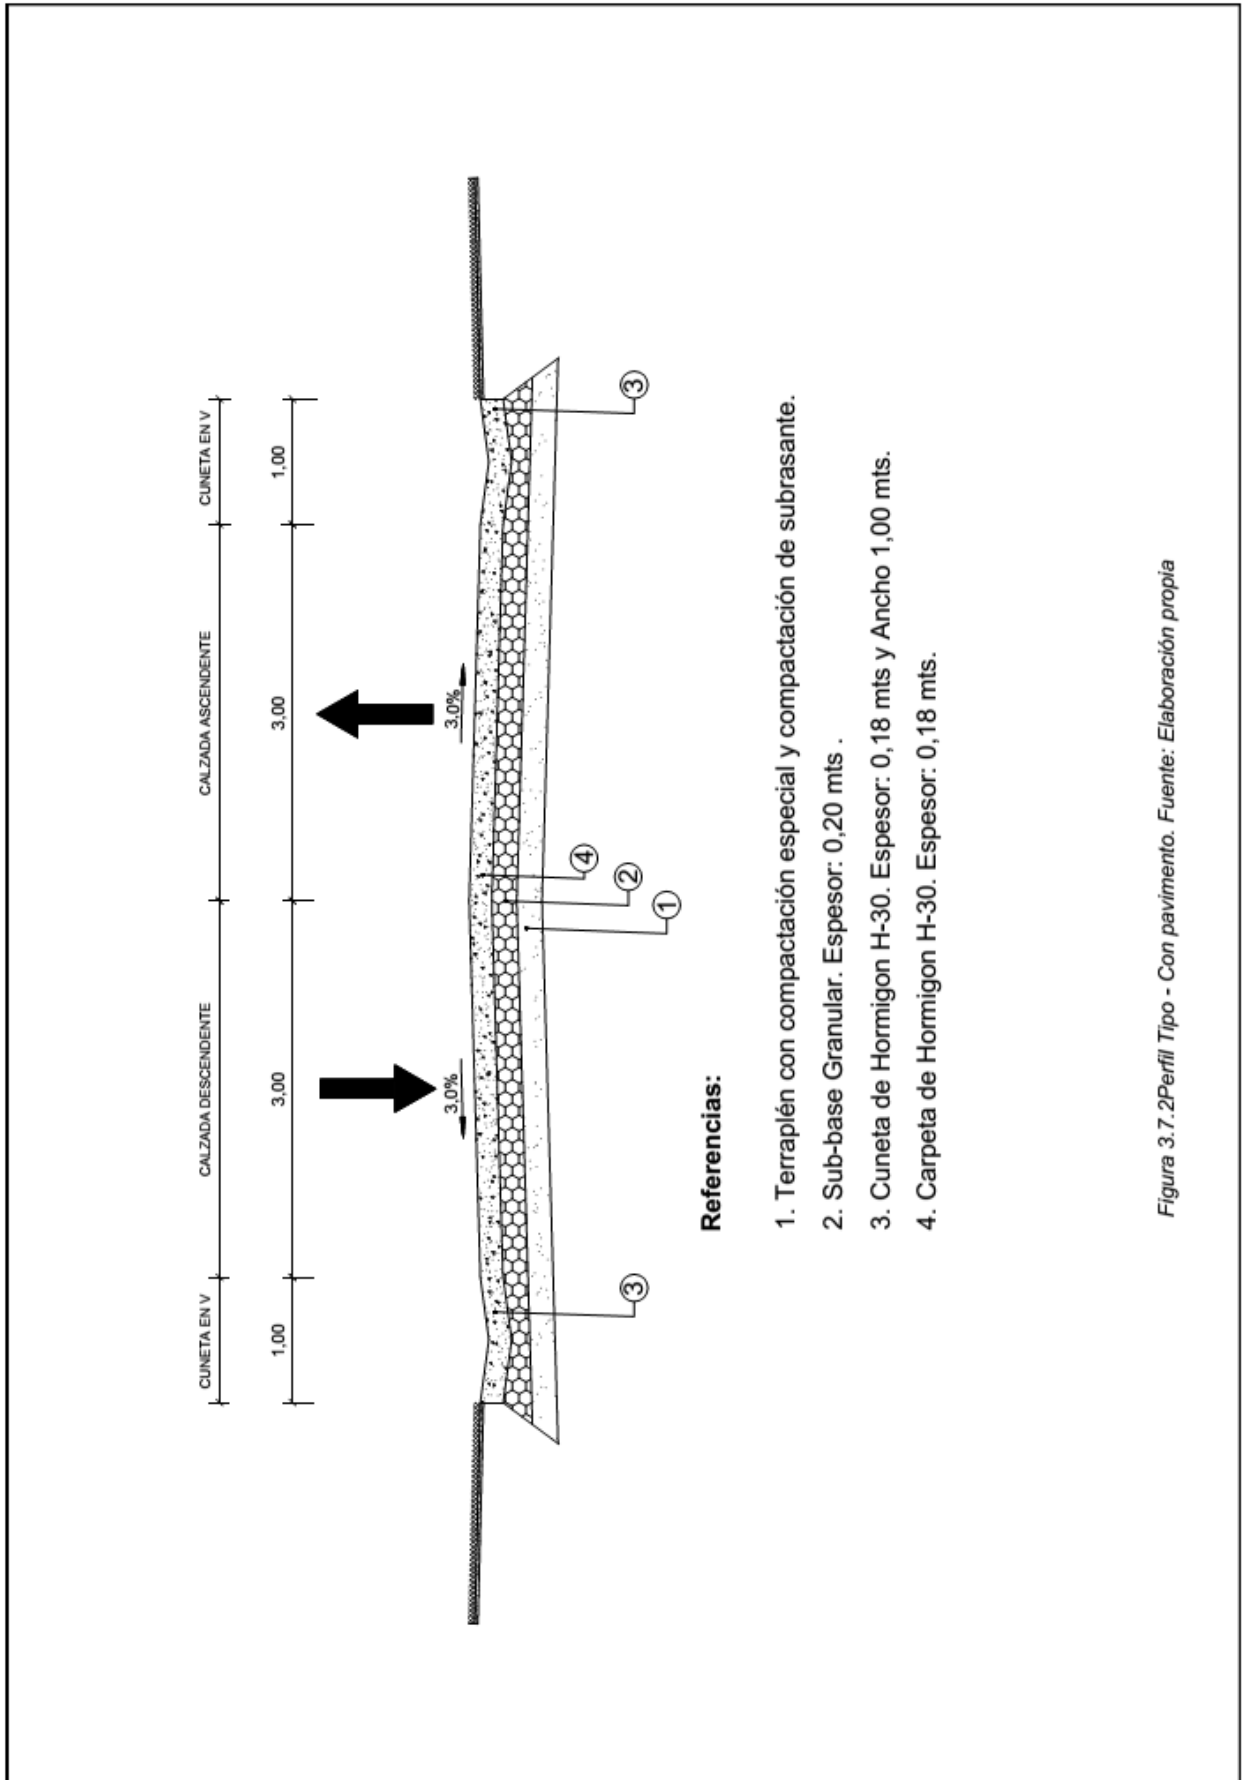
Perfil Tipo - Con pavimento. Fuente: Elaboración propia
